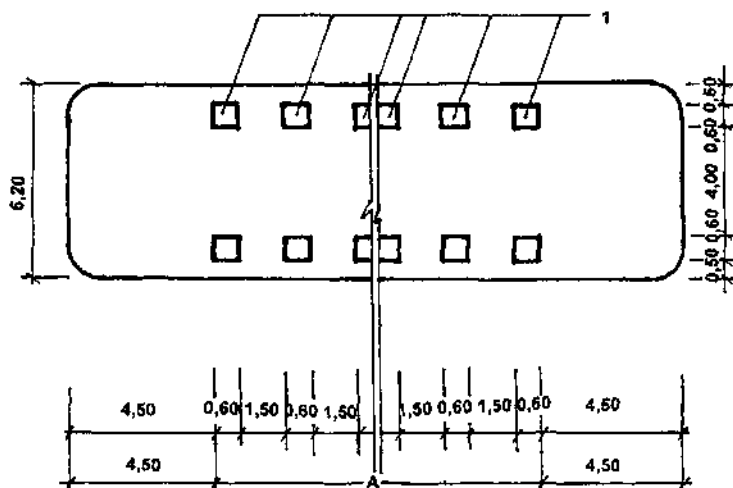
План расстановки ульев на участке фрагмента генерального плана:
